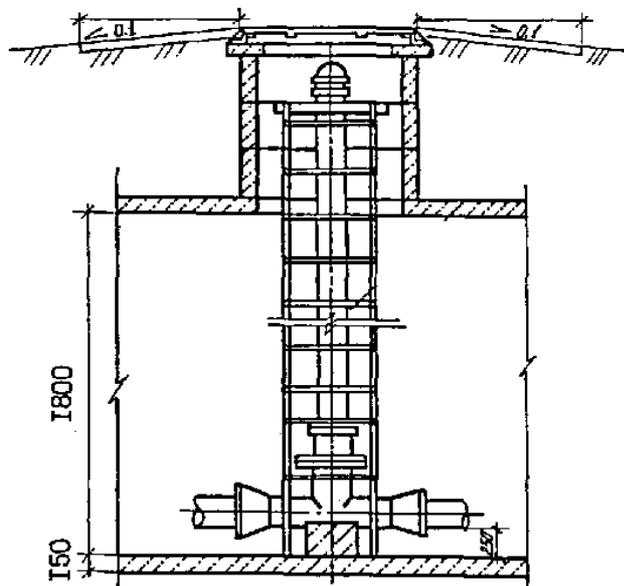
Схема установки пожарного гидранта на водопроводной сети
